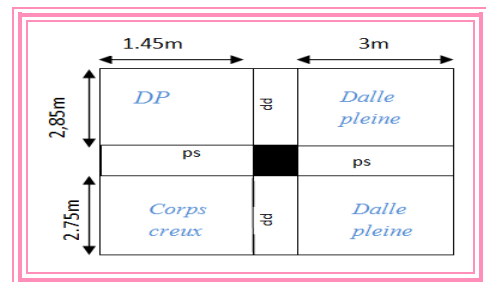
la surface afférente du poteau « C4 » pour les étages de 8 à 2
